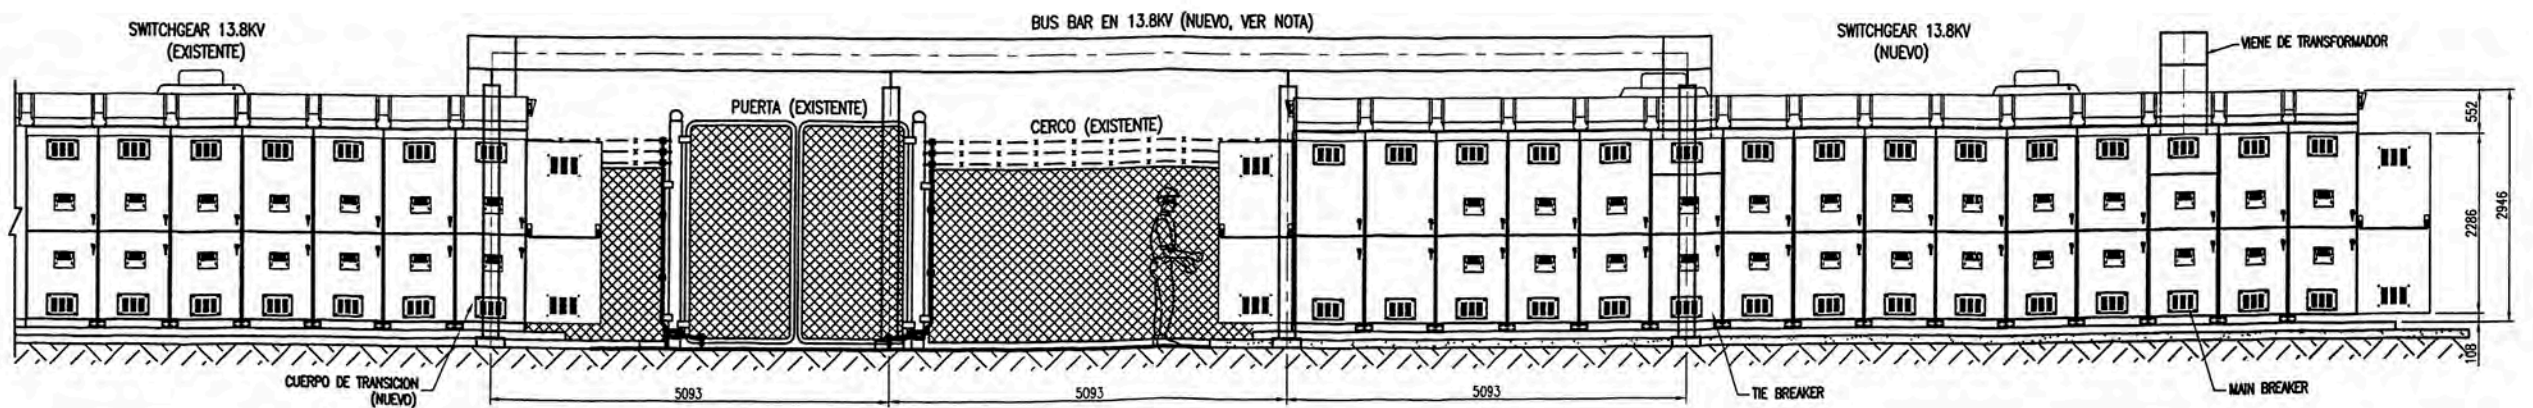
Vista General de Planta-Subestacion Electrica
